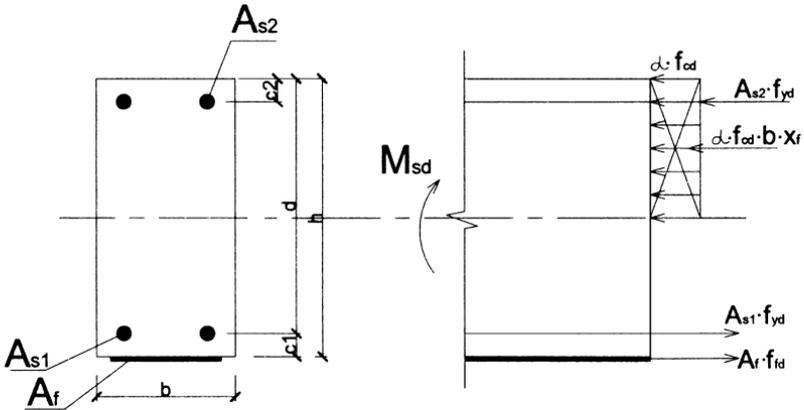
Схема усилий и эпюра напряжений в сжатой зоне нормального сечения усиленного изгибаемого элемента
